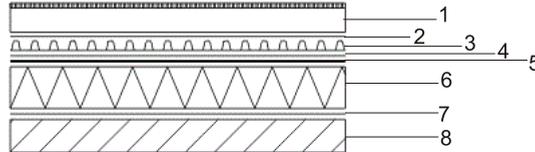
Стандартная зеленая кровля: 1 — почвенный слой; 2 — геотекстиль; 3 — дренажное полотно Максдрейн; 4 — геотекстиль; 5 — мембрана Преласты (1,5 мм); 6 — теплоизоляция; 7 — пароизоляция; 8 — бетонная плита
